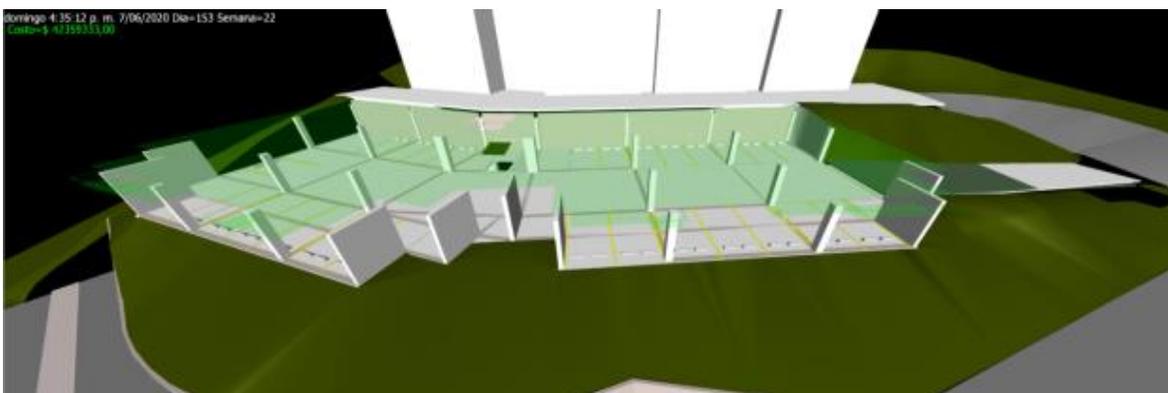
Proceso 04. Vaciado de placa de fundación, rampa de acceso a sótano. Navisworks
